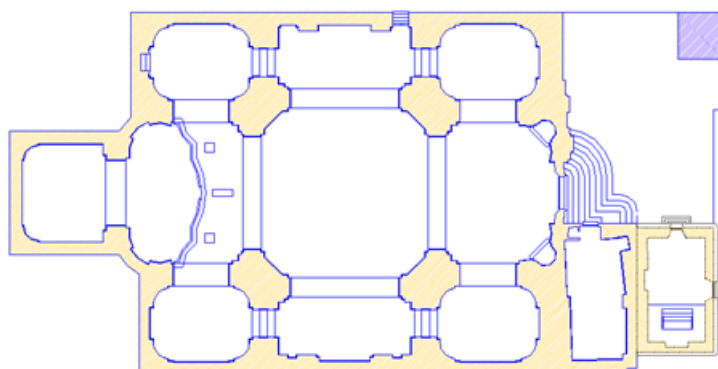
Santa Maria Maggiore della Pietrasanta. La Pianta
